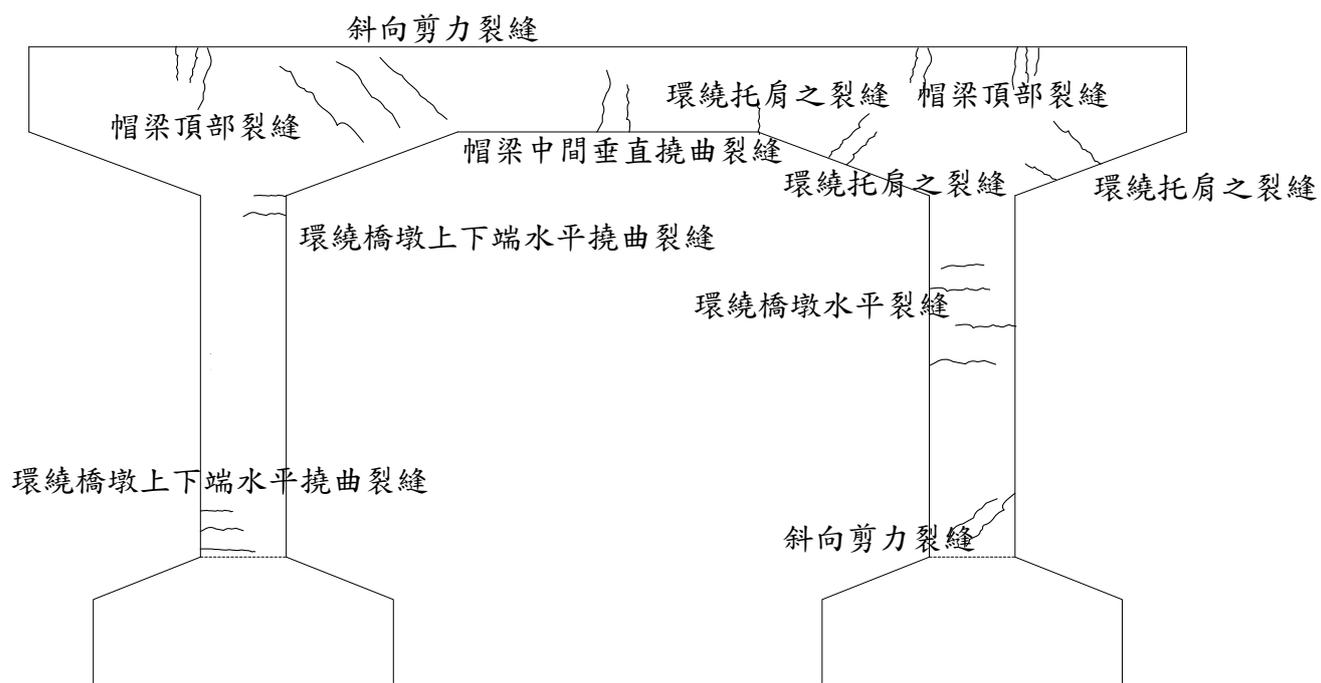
混凝土構架式橋墩裂縫示意圖
